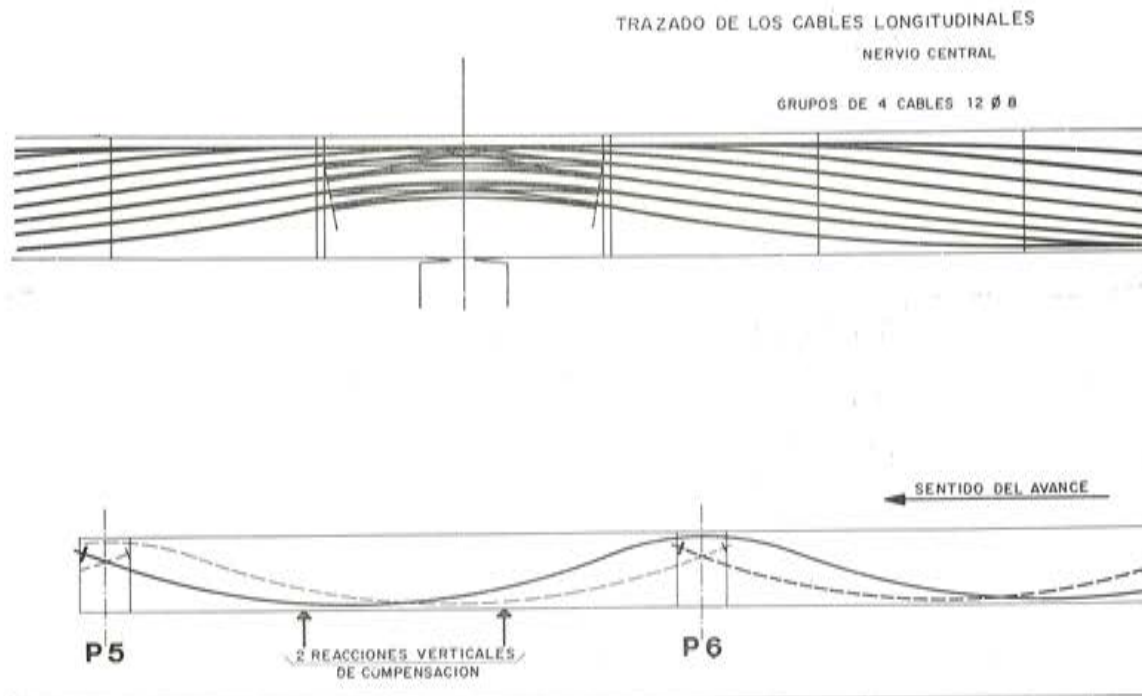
Trazado longitudinal de los cables de pretensado en la estructura.
